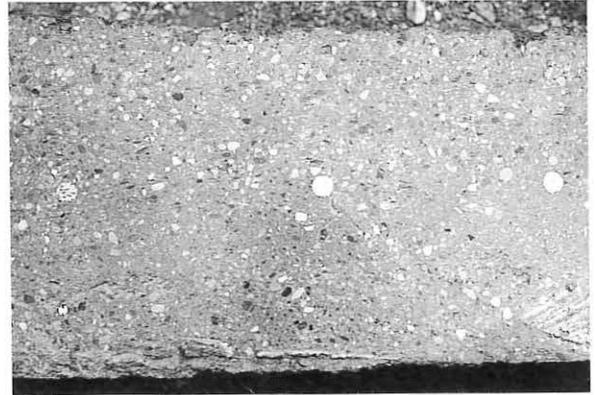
Vollständig mit Spritzbeton eingebettete Bewehrungsmatten
